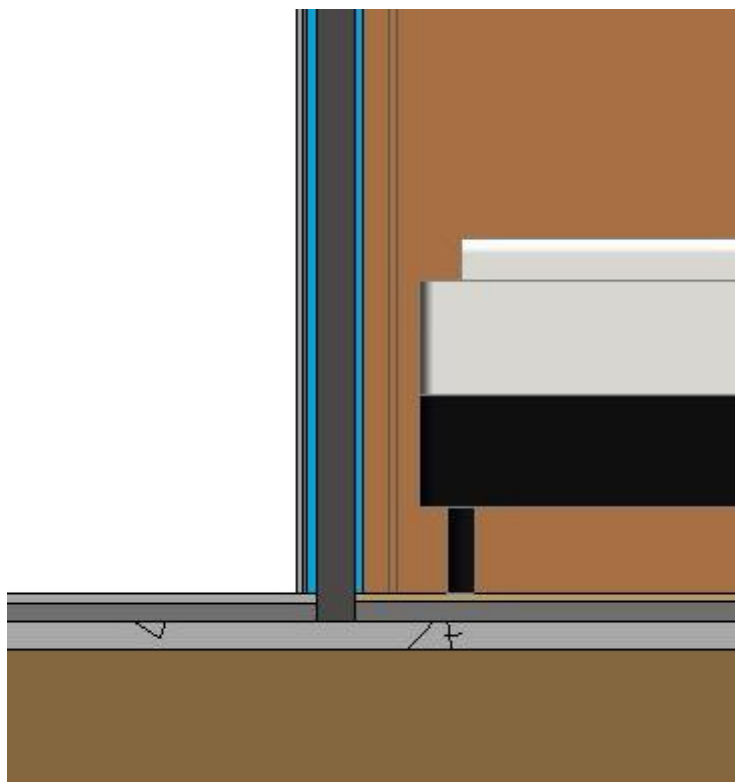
Detalle del encuentro de tabique con el pavimento en Revit. Fuente: Elaboración Propia
